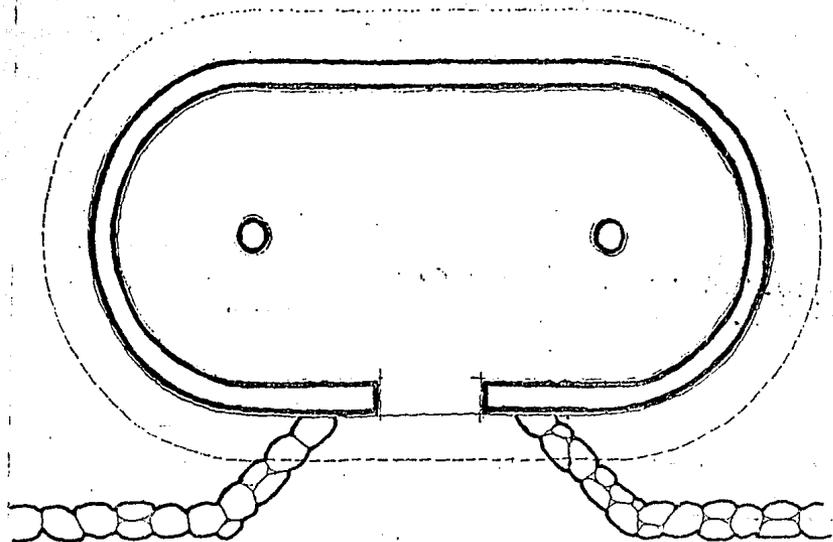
Tipo arquitectónico R.2.1, Mallnaco, conjunto tallado en la montaña.
